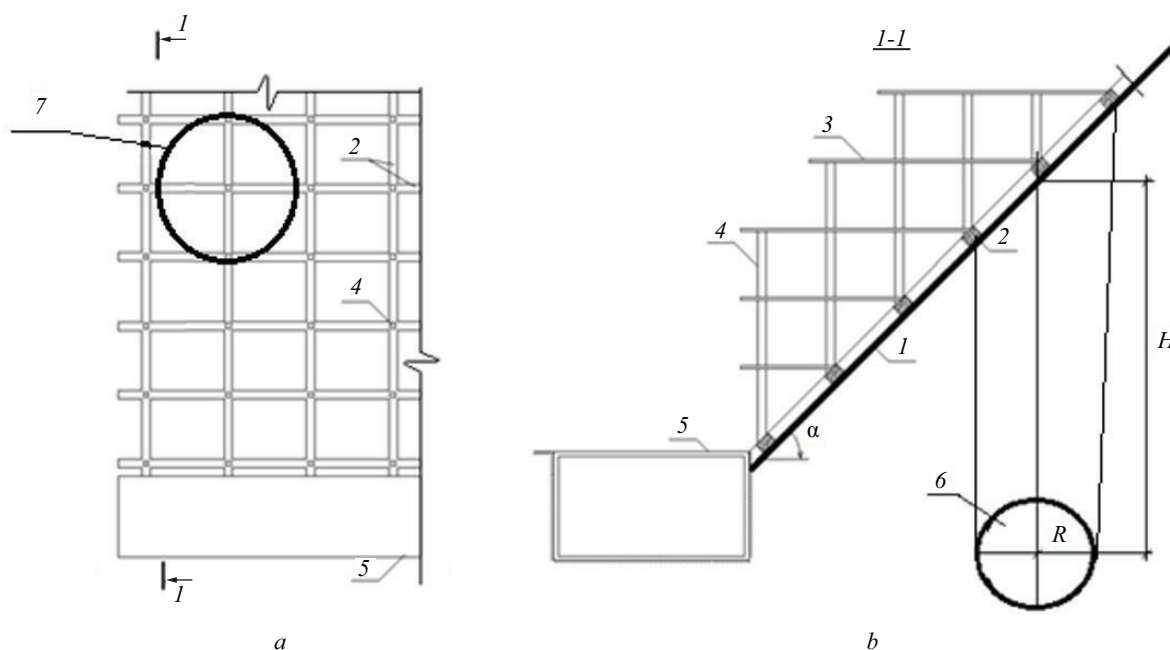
Схема здания на склоне: 1 — продольные балки фундаментной решетки; 2 — поперечные балки фундаментной решетки; 3 — диски перекрытий; 4 — вертикальные несущие элементы (колонны); 5 — удерживающая заглубленная конструкция; 6 — карстовая воронка; 7 — проекция карстовой воронки на плоскость склона
